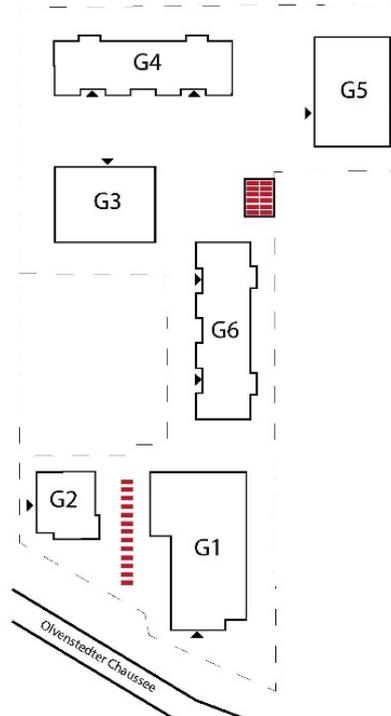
25 Radbügel an 2 Orten zentral gebündelt (Alternative)
